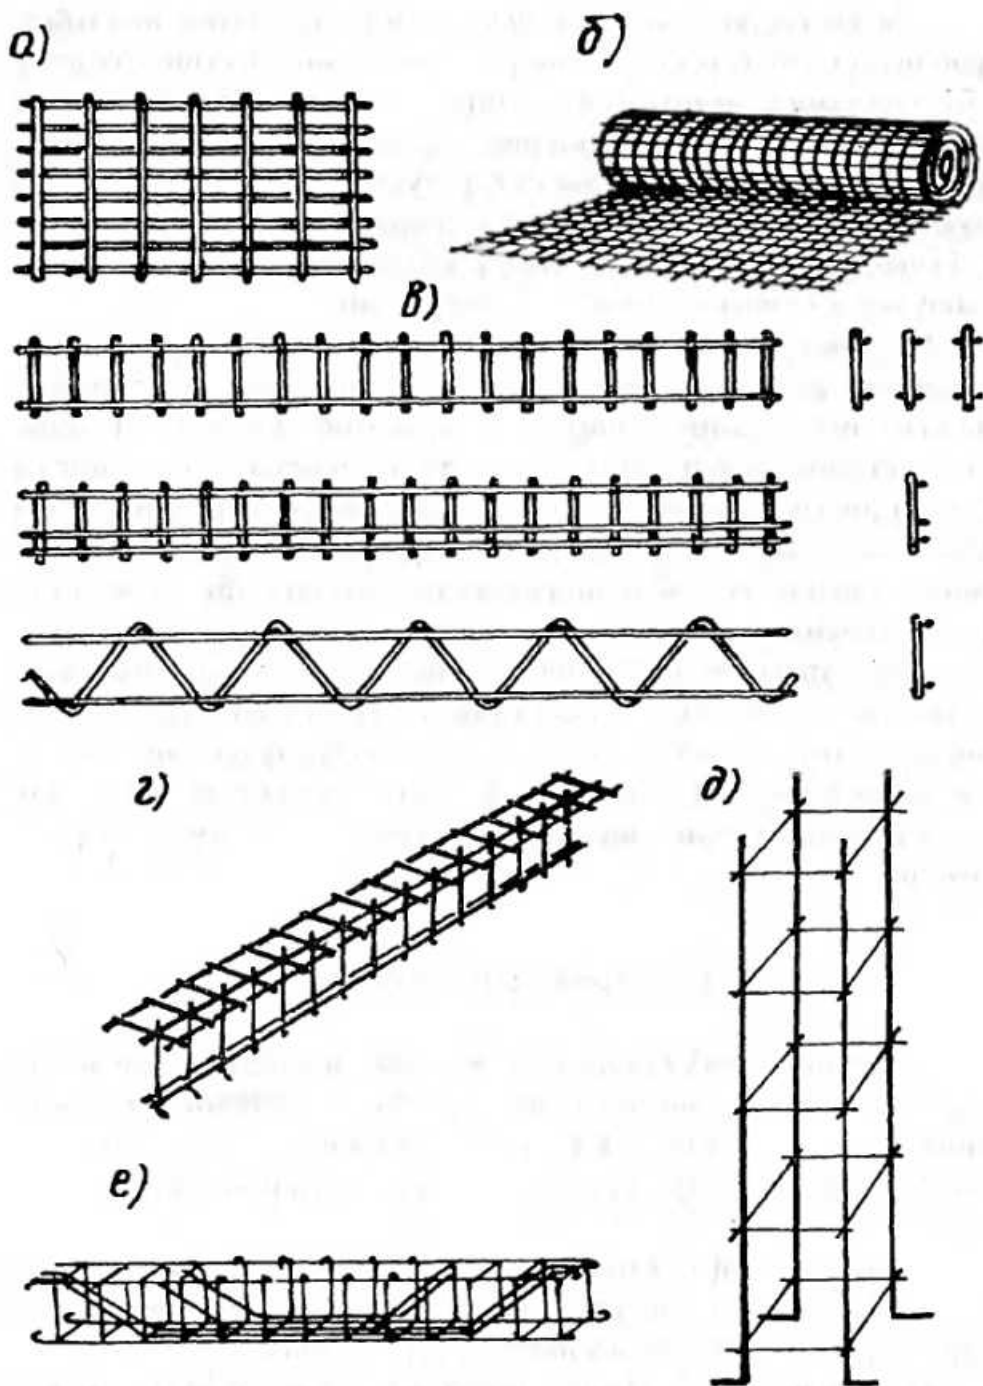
Зварні каркаси та сітки для армування залізобетонних конструкцій: а) плоска сітка; б) рулонна сітка; в) плоскі каркаси з двома, трьома і чотирмаподовжніми стержнями; г) каркас таврової балки; д) каркас колони; е) каркас балки із зігнутих стержнів круглої арматурної сталі
